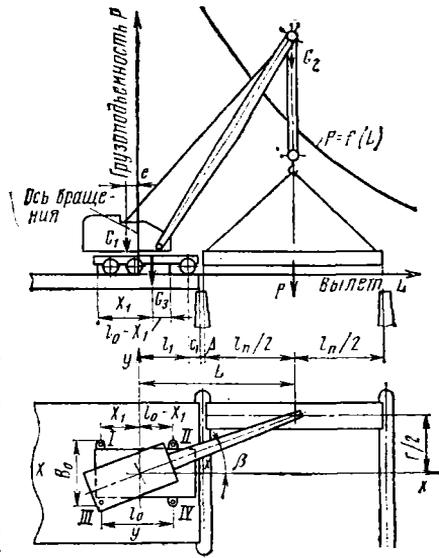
Схема к расчету установки балок стреловым полноповоротным краном перед собой
